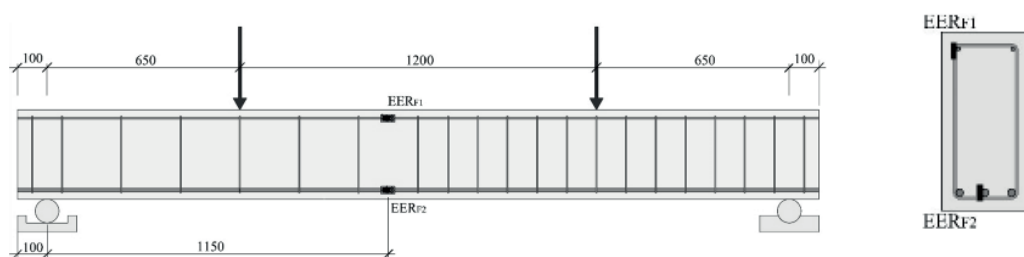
Pontos de análise da armadura longitudinal (adaptado de Gomes, 2016).
